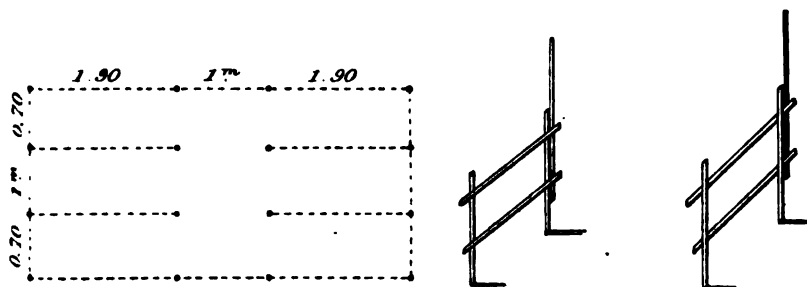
Plan et disposition d'une tente pour huit malades couchés.
